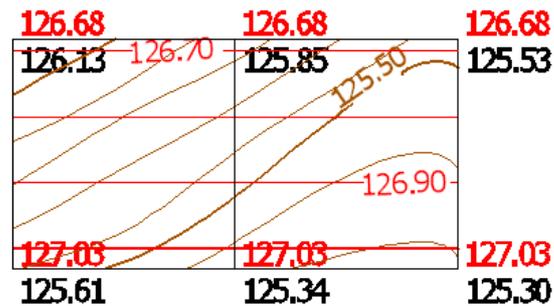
Виділений фрагмент сітки квадратів з аркуша «План вертикального планування ділянки перону»
